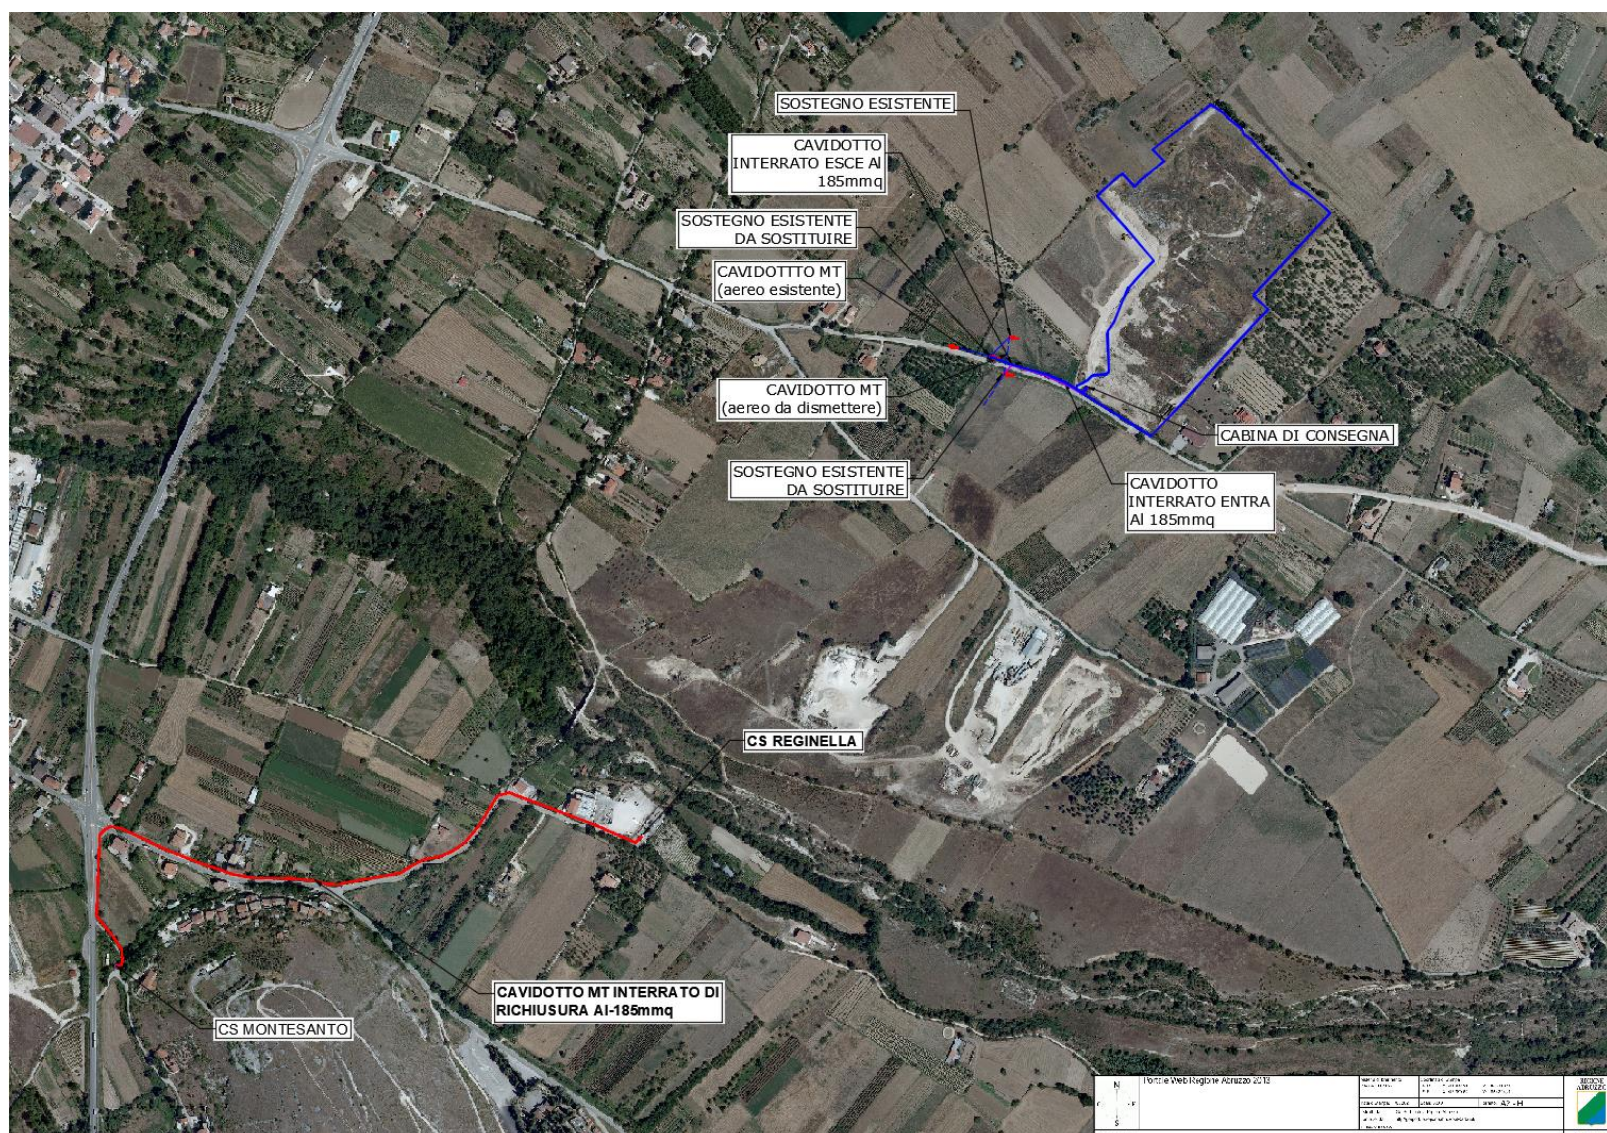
planimetria del lotto di produzione e delle opere di connessione
